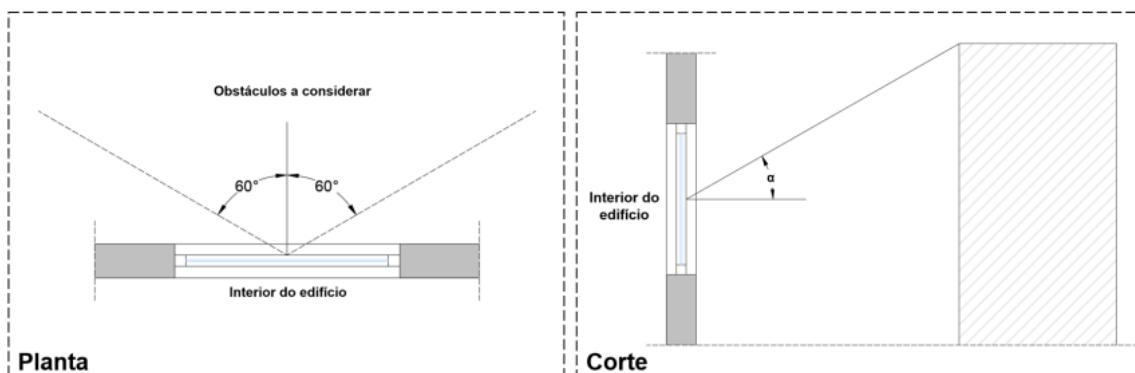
Identificação da zona relevante para contabilização dos obstáculos no horizonte. [8]
